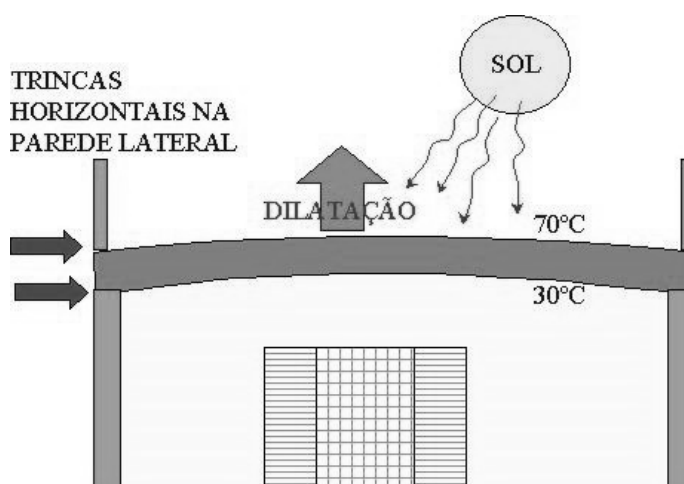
Fissuras de cisalhamento provocadas por expansão térmica da laje de cobertura.
